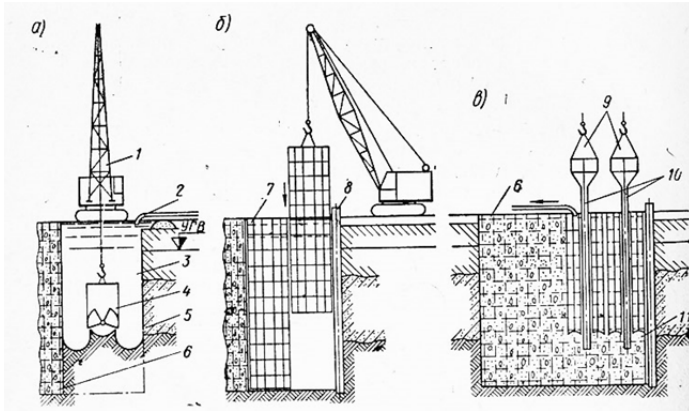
Схема влаштування монолітної залізобетонної стіни в ґрунті:
